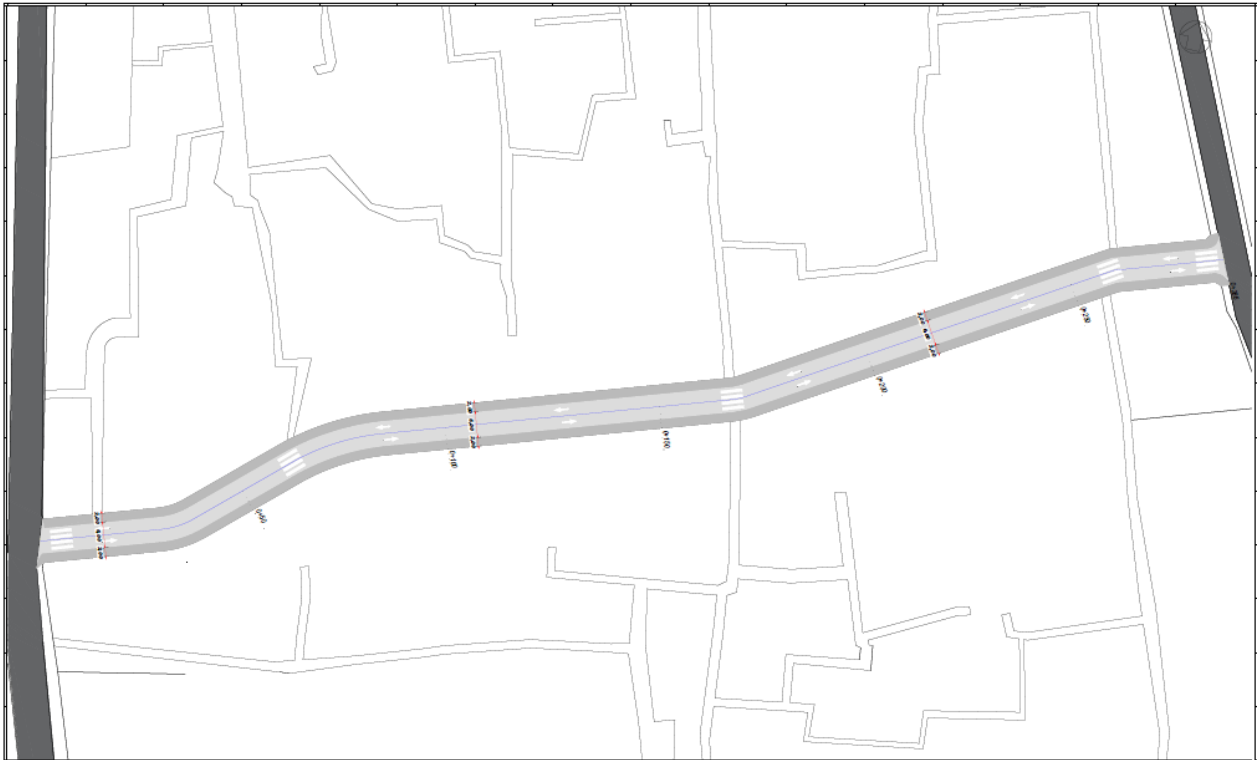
Planimetría de pavimento apertura Calle Chacabuco
